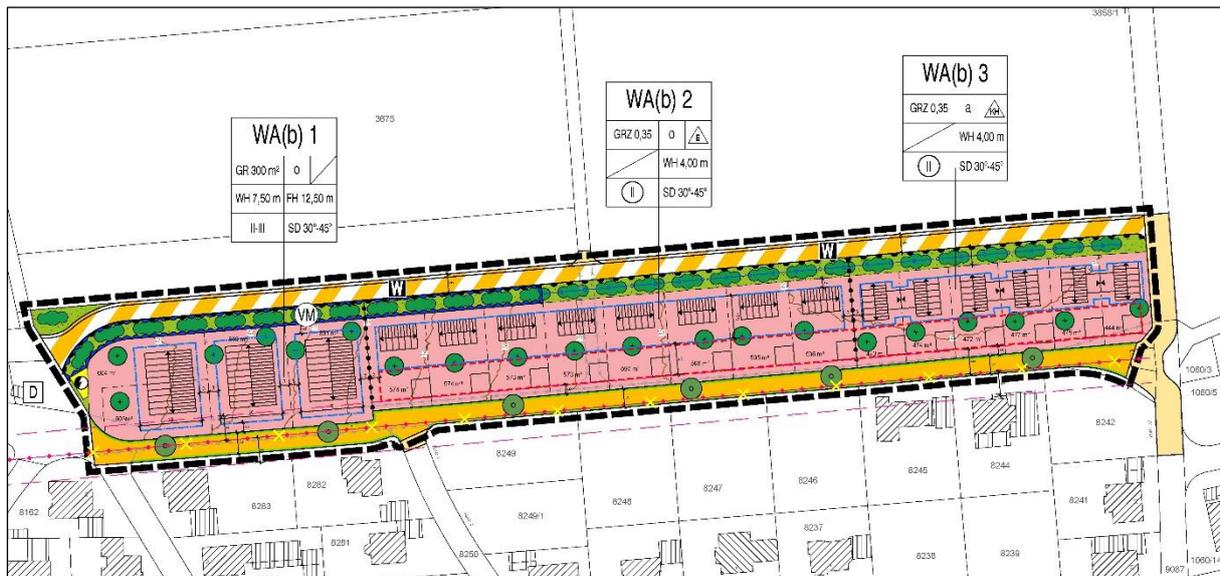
Planzeichnung Bebauungsplan „Am Gründlein II“
